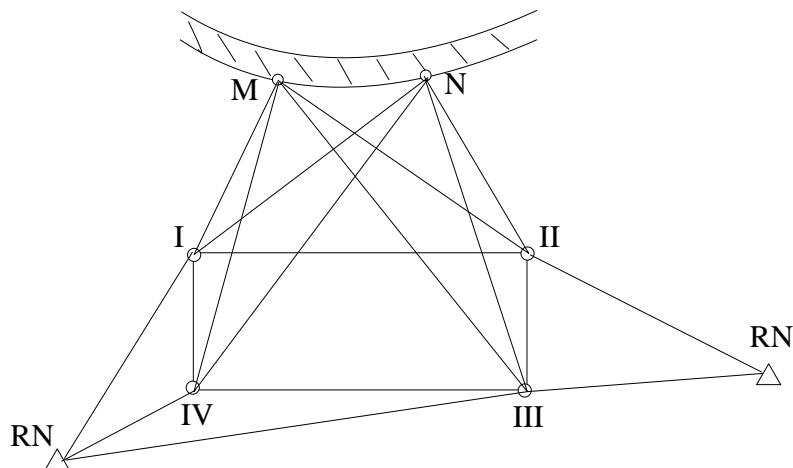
Vista em planta da triangulação efetuada entre as estações e os pontos da barragem
